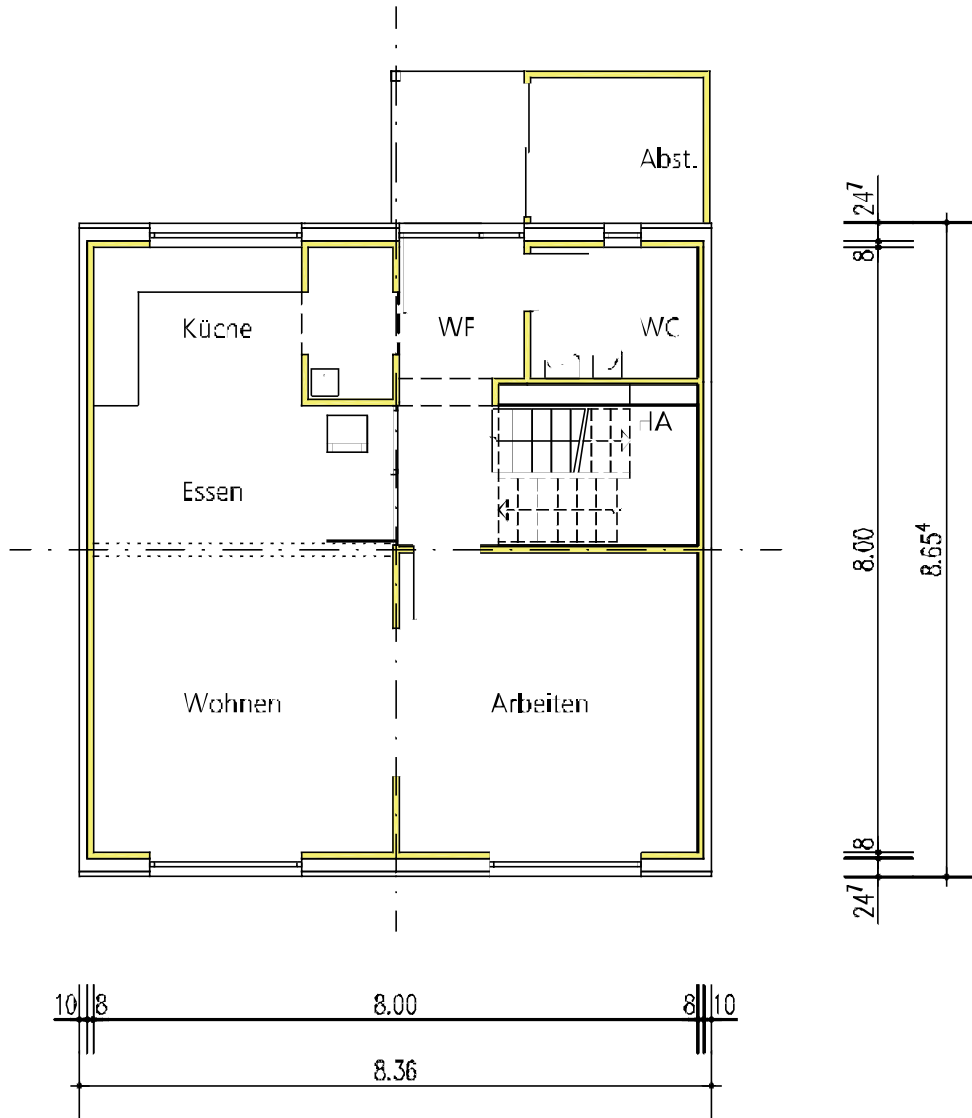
Grundriss EG, zusätzlicher Raum, M 1:100
